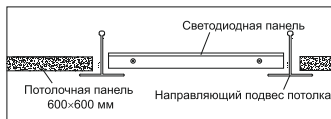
Встраиваемый монтаж/ Figure A.2 – built-in installation/ A. 2 sýreti – Ýñgailastyrylgan montaj/ Рисунок А.2 – Вбудований монтаж
